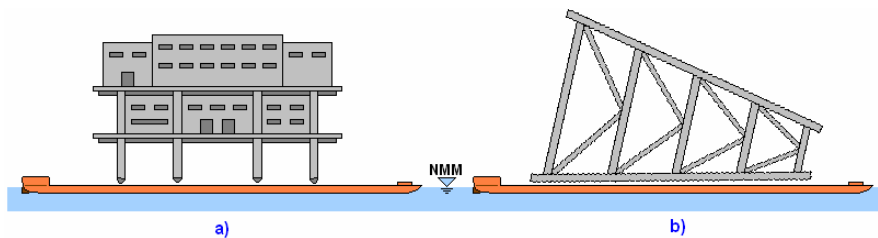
Transportación. a) Subestructura, b) Superestructura.
